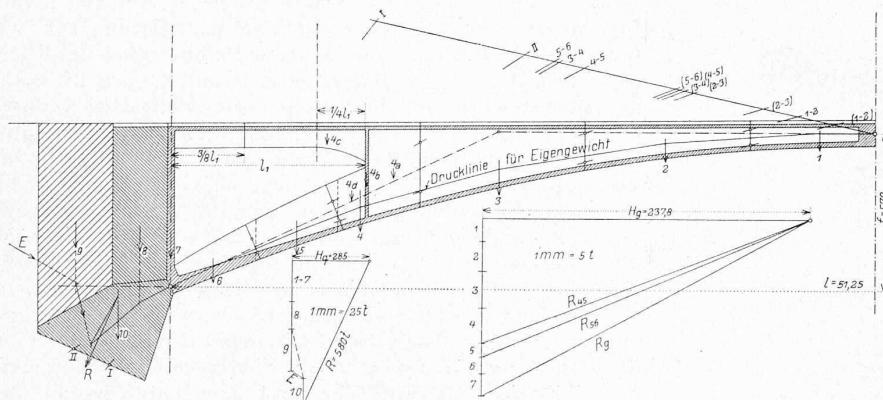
Längsschnitt 1:250 einer Brückenhälfte mit Kräfteplan.
